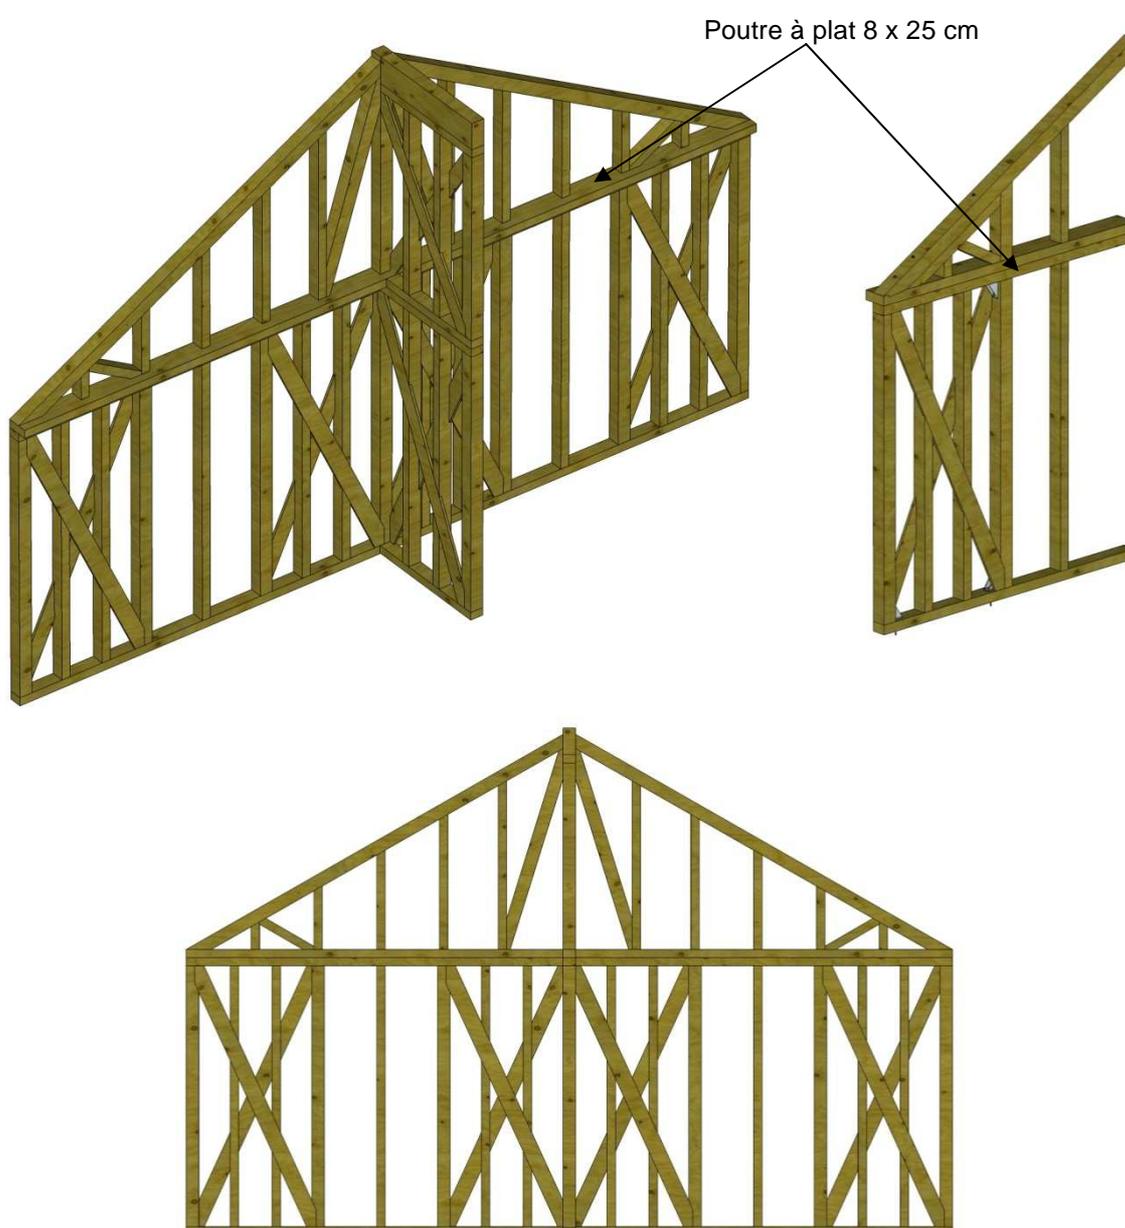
Schémas de principe des murs pignon des maisons à toiture à 2 versants.
